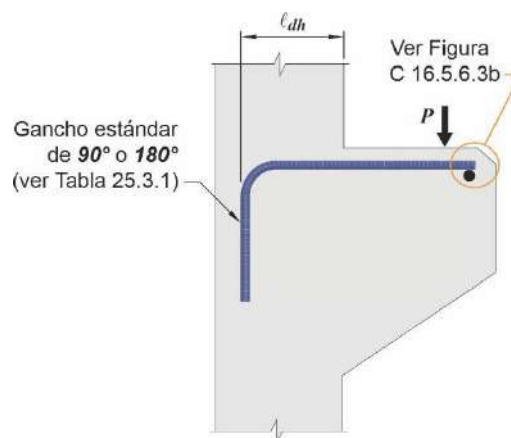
Elemento dependiente del apoyo y extremo de los anclajes
